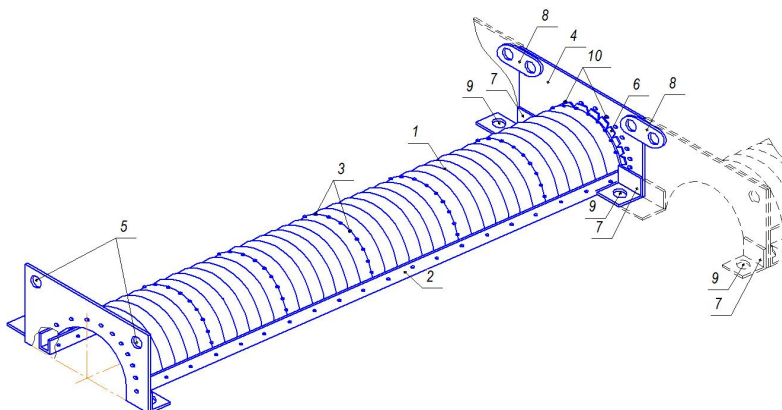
Изометрический вид арочной конструкции из гофрированного металла для водопропуска:
